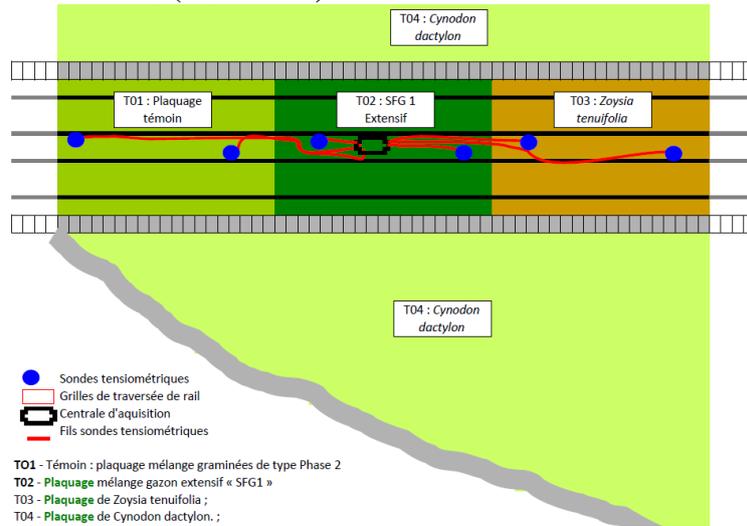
Plan et légende de la zone d'essai arrêt Tauzia (Bordeaux)
